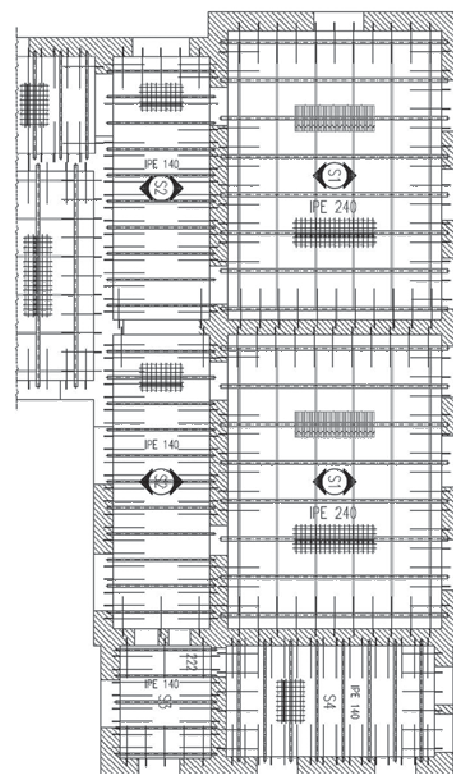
Stralcio della carpenteria con indicazione planimetrica dei grip-round
